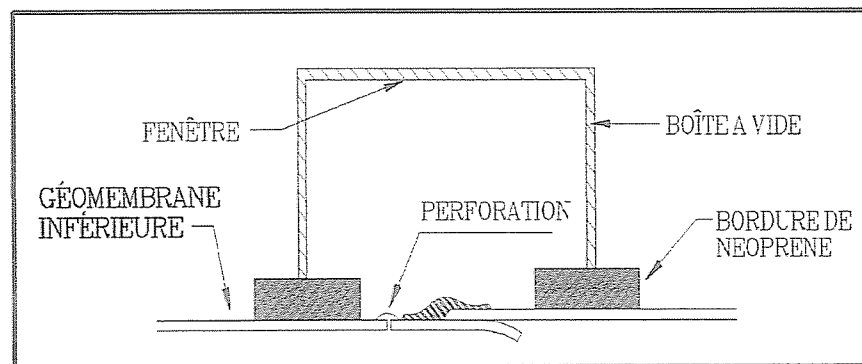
Essai de la boîte à vide pour joints de géomembranes
